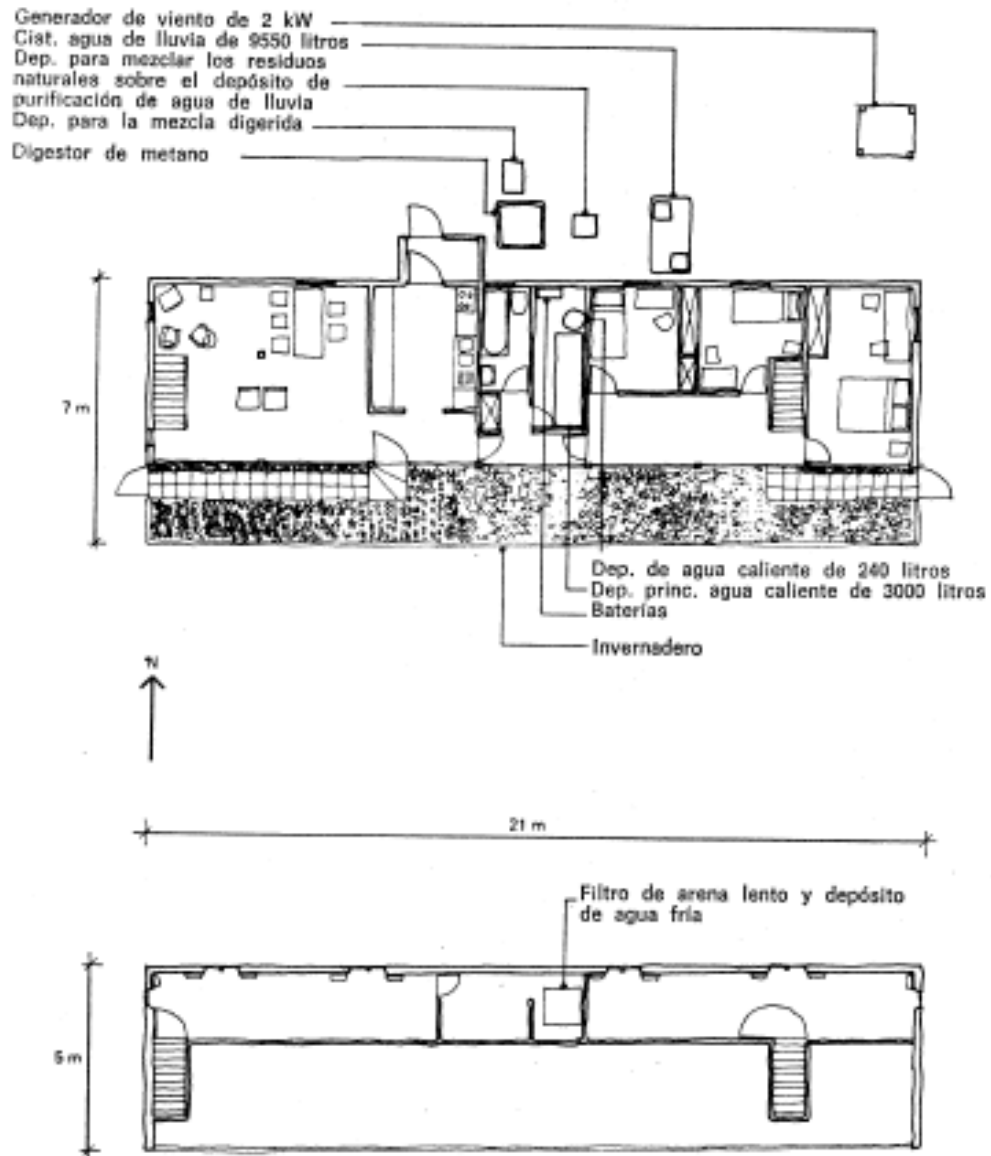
/ 12: Planta baja y planta primera de casa autónoma. Blenda y Robert Vale.
